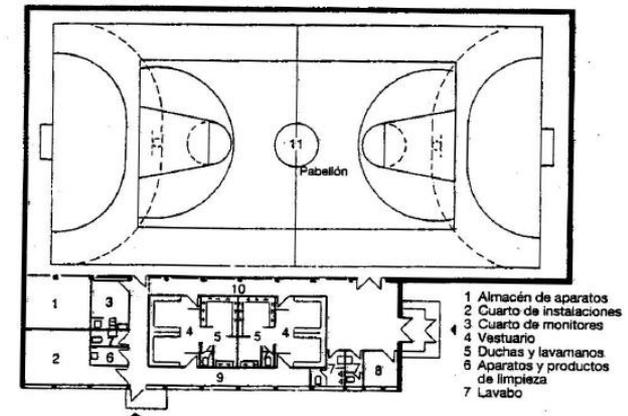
Planta esquemática de superficie de juego. Fuente: Neufert.
